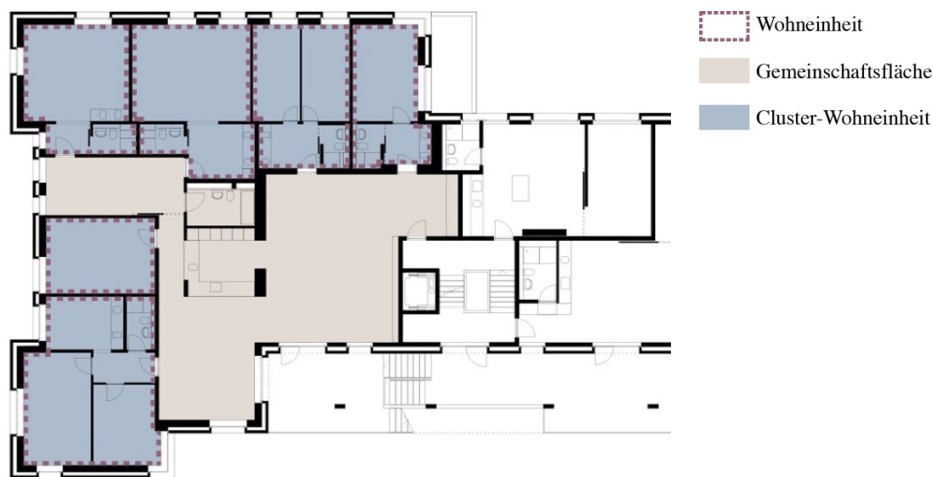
Grundriss geschlossene Clusterwohnung, Beispiel Kraftwerk1 Heizenholz (Adrian Streich Architekten; eigene Darstellung)
